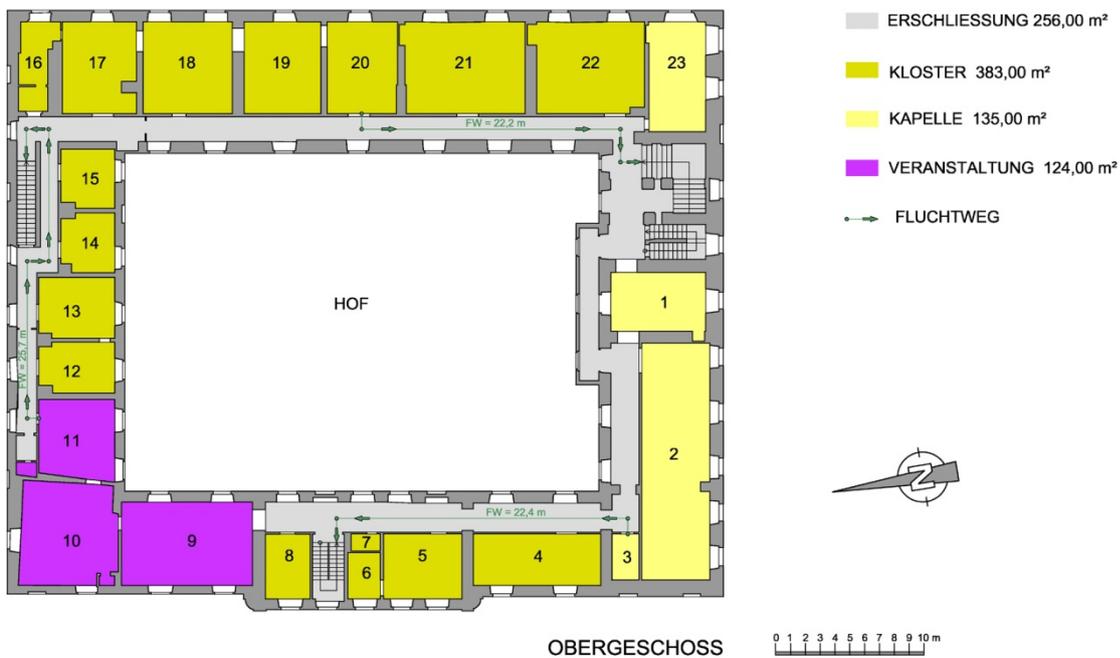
zeigt den Grundriss des Schlosses Obersiebenbrunn
